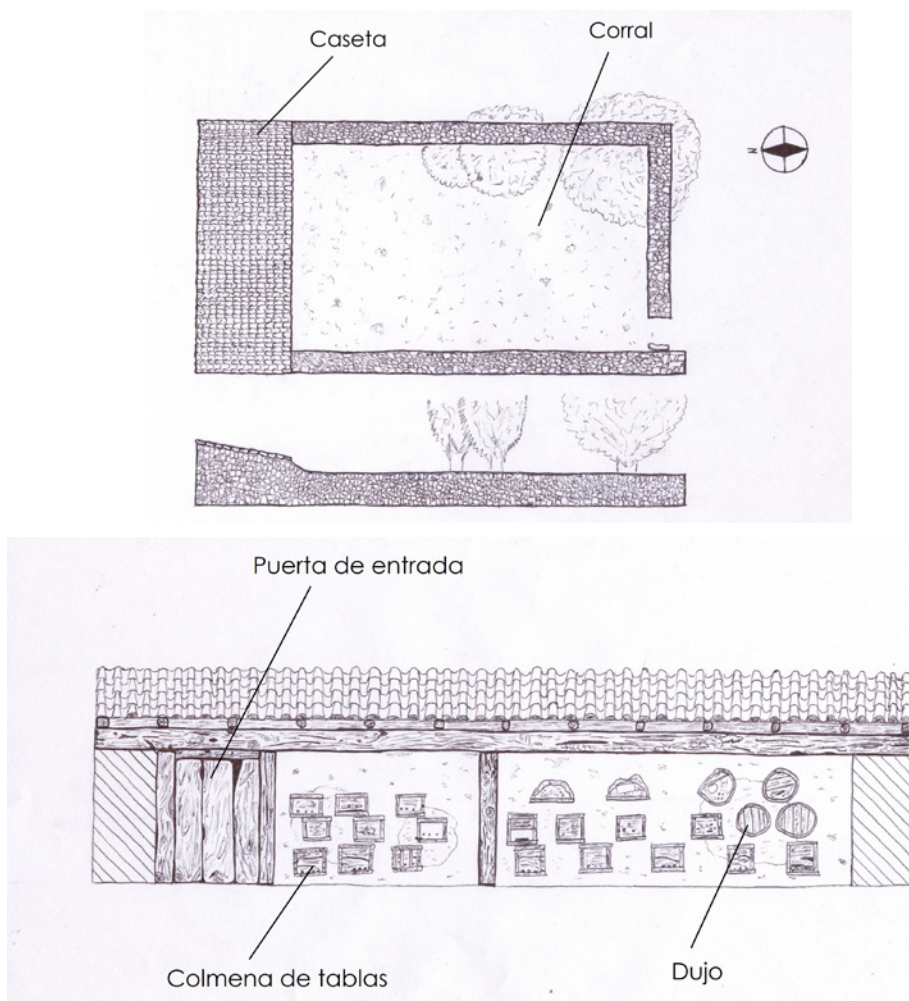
Colmenar de Vallespinoso de Aguilar (municipio de Aguilar de Campoo). Arriba: planta y perfil del conjunto. Abajo: alzado de la caseta. Fuente: Elaboración propia
